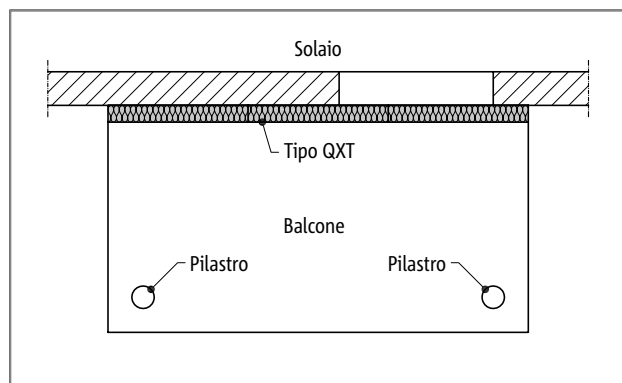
Schöck Isokorb® tipo QXT: balcone con appoggio su pilastri
